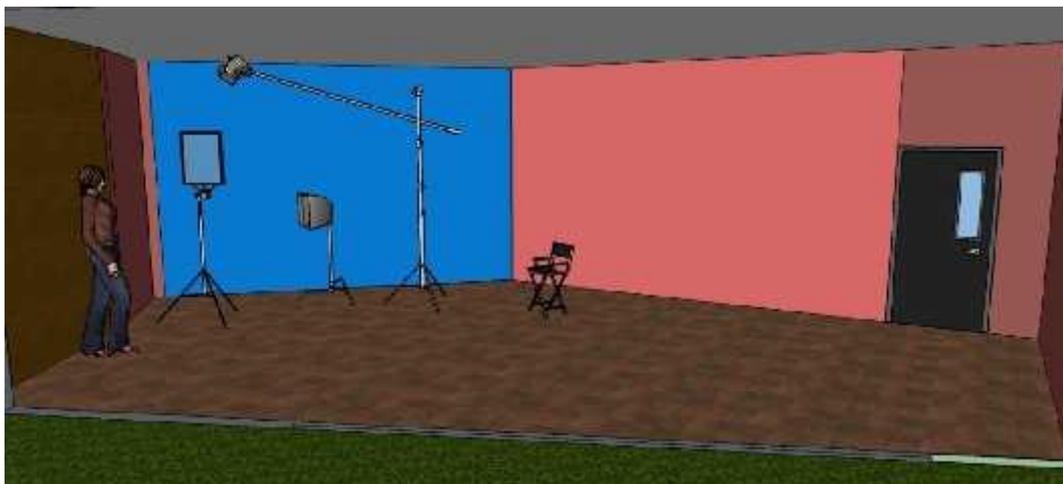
Tampak Studio Foto Dengan Folding Wall
